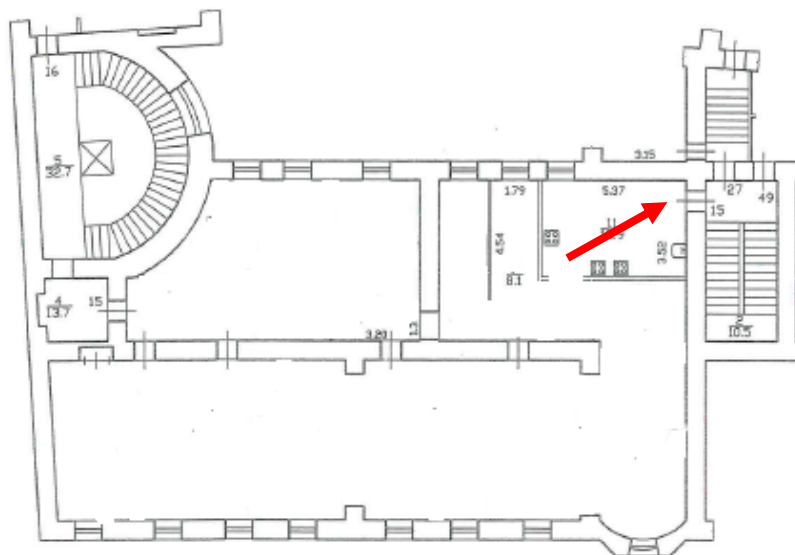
Квартира №15, общий вид помещения. Кухня. Выход на черную лестницу.
